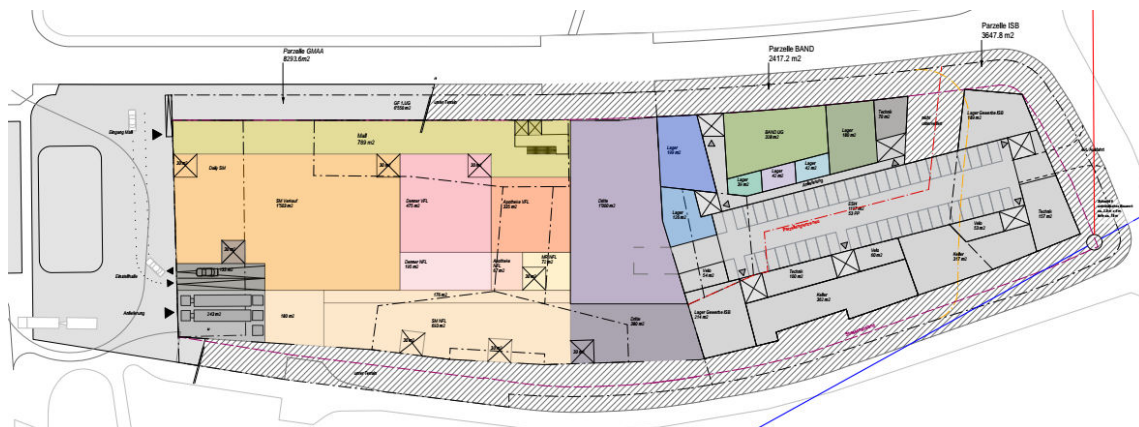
Grundriss 1. UG mit Verkaufs- und Parkierflächen
